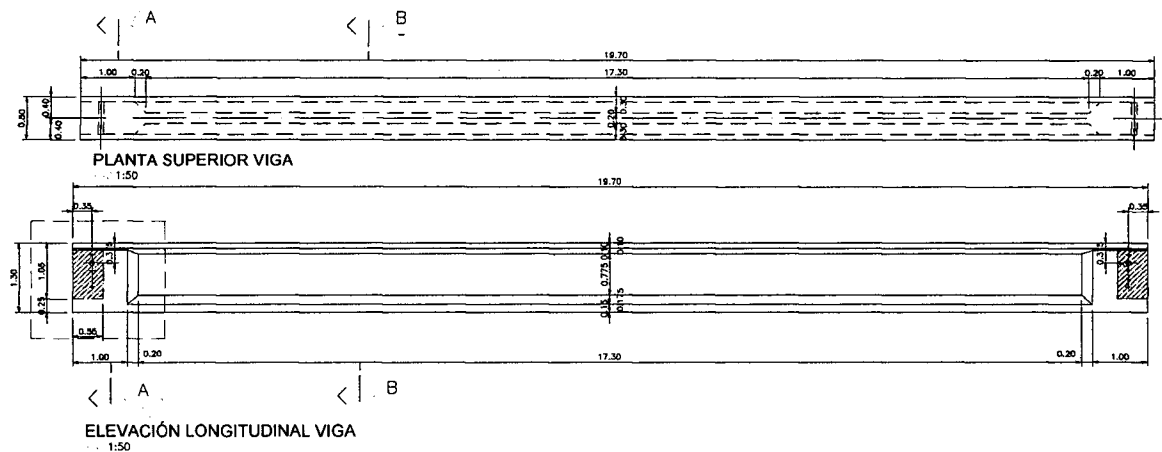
Dimensiones de Viga Típica  $h=1.30$  y  $L=19.70$ m, vista en Planta y elevación
